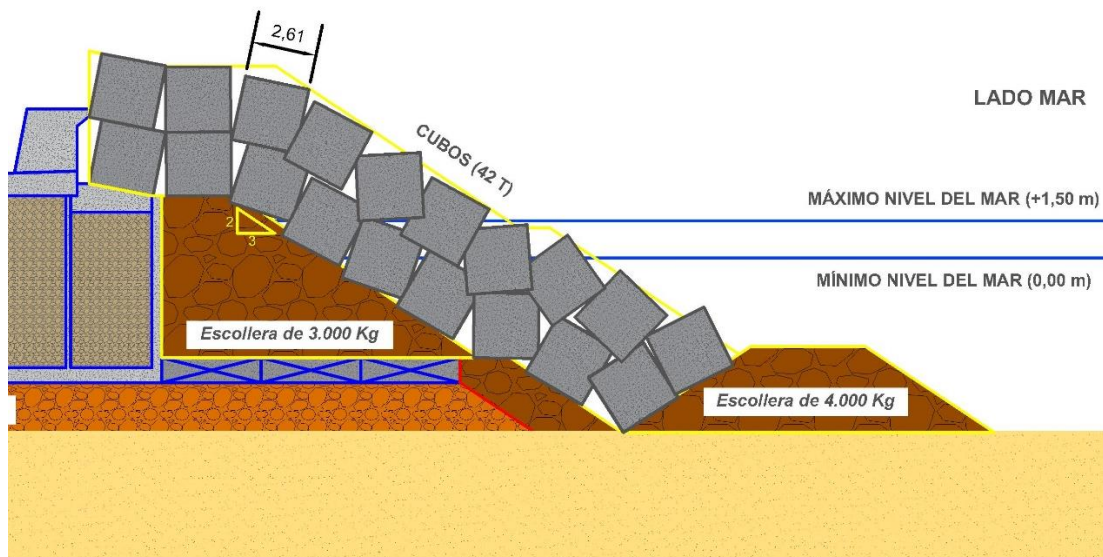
Sección tipo de la alternativa D. Cotas en m.
